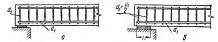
Анкеровка сварных каркасов на свободных опорах балок: а — поперечнан арматура по расчету не требуется; б — поперечная арматура требуется по расчету.
